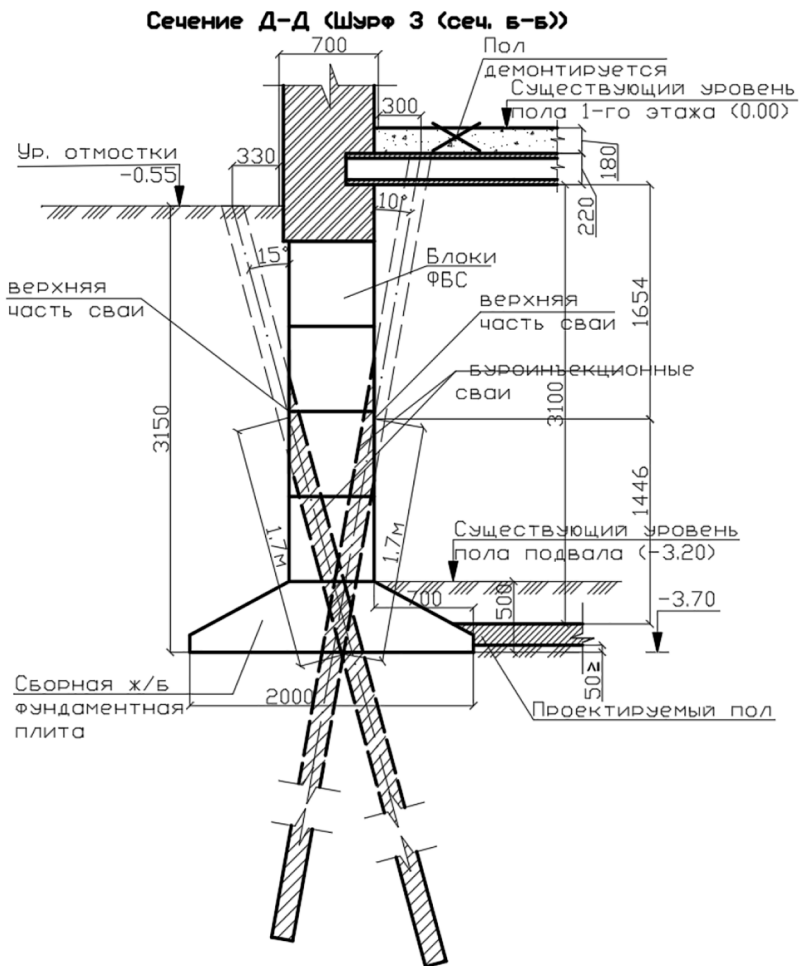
Поперечное сечение Д-Д усиленного основания фундамента
